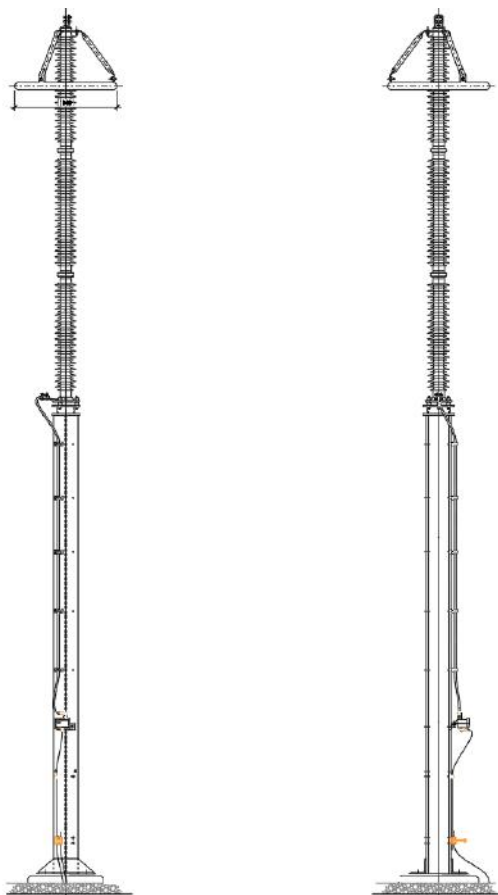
Alzado principal y lateral de las autoválvulas de 400 kV.
